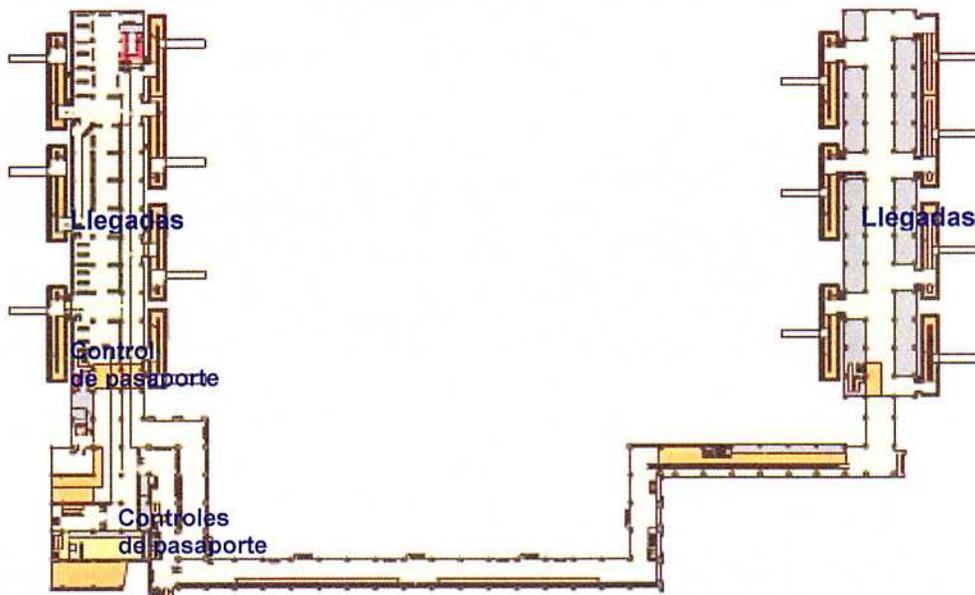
Planta primera (Nivel 07). Terminal T2
